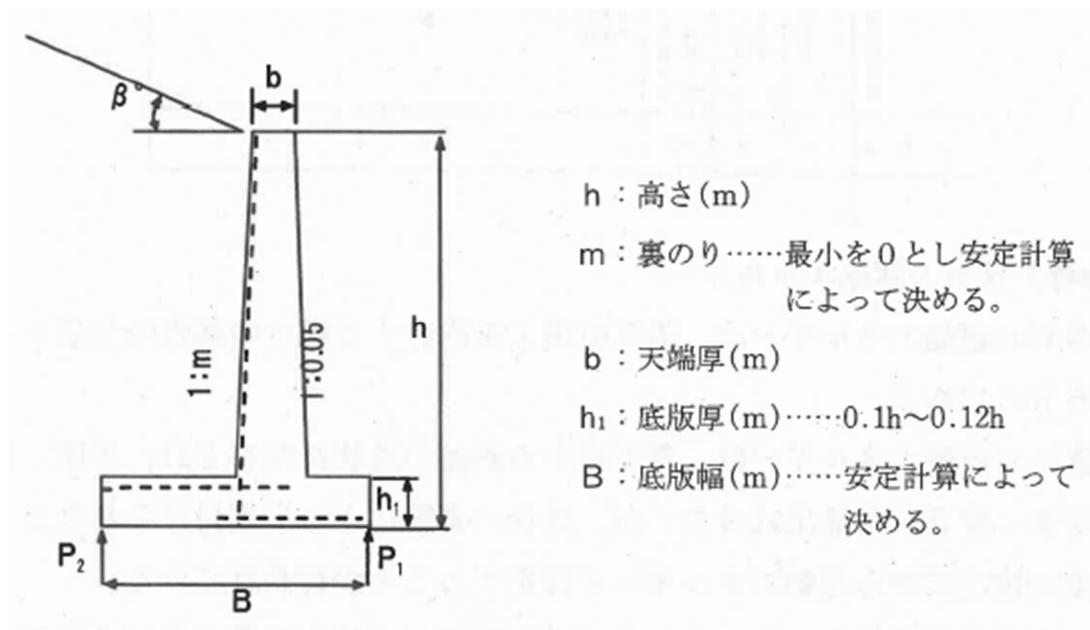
鉄筋コンクリート土留工（逆T式構造）の断面
